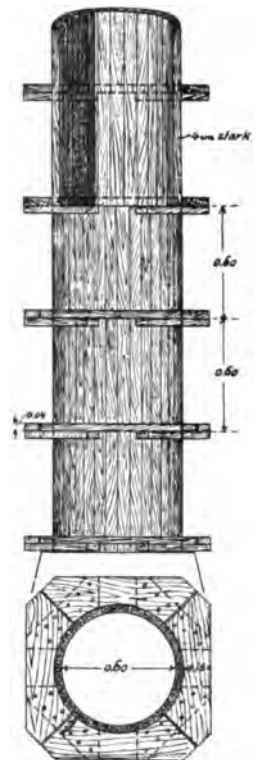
Schalung einer runden Säule. Schalldielen durch Holzringe zusammengehalten.
